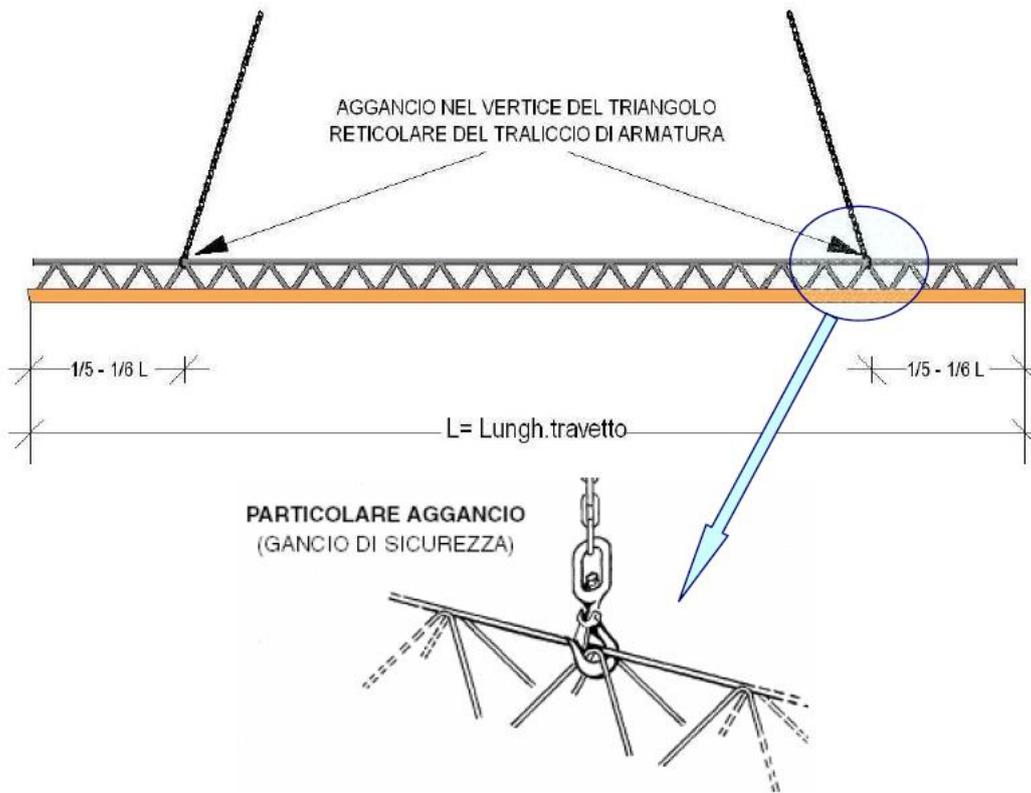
Punto di sollevamento del travetto tralicciato al vertice del triangolo del traliccio
